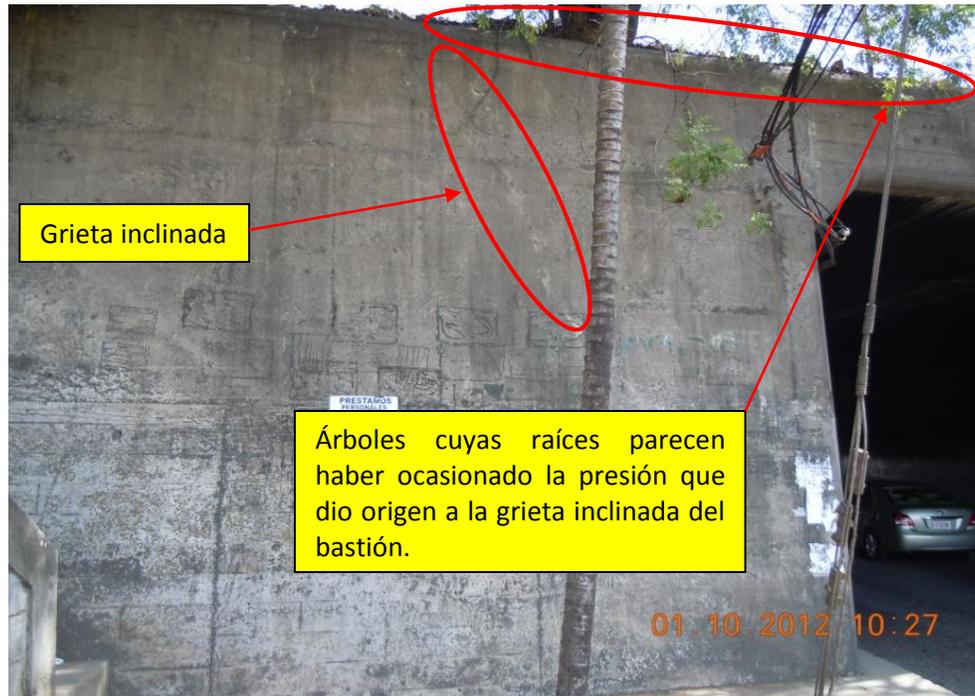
Grieta en una dirección en el aletón noroeste - bastión de Alajuela.
